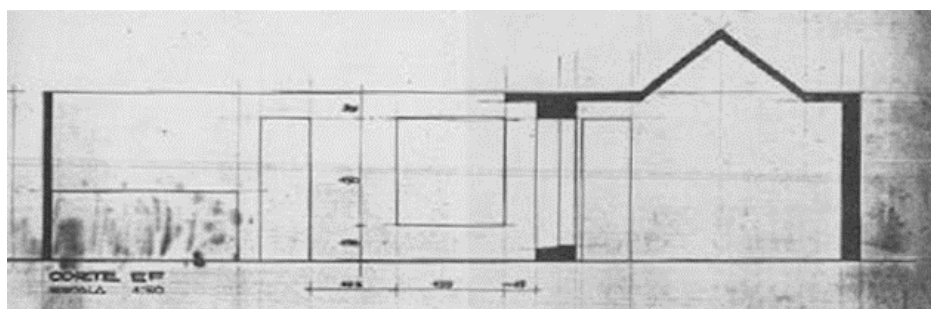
Casa de veraneio de Dieste. Corte da casa com a laje plissada.
